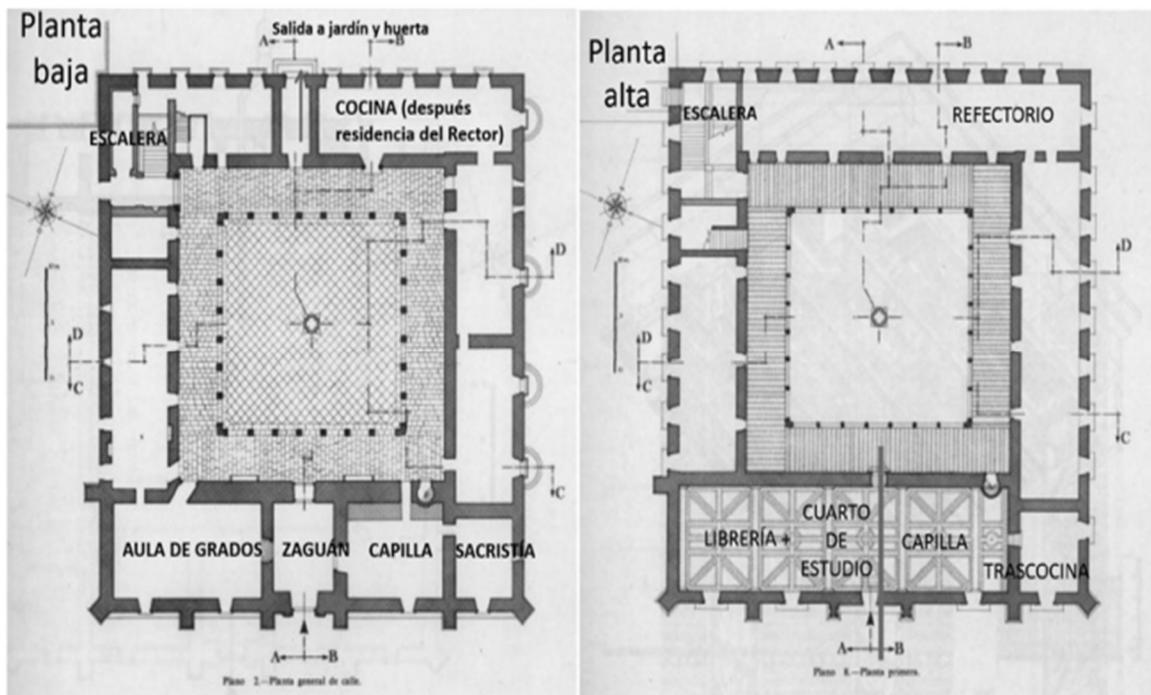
Planta del Colegio de Santa Cruz de Valladolid. Indicaciones de la autora sobre plantas de Cervera Vera 1982.
